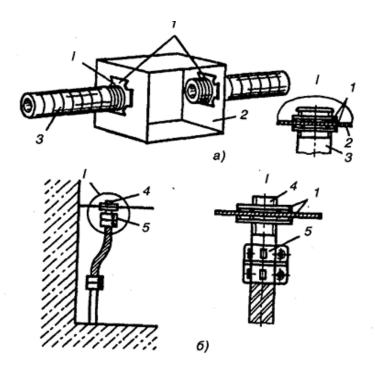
Примеры монтажа электропроводок в трубах:
